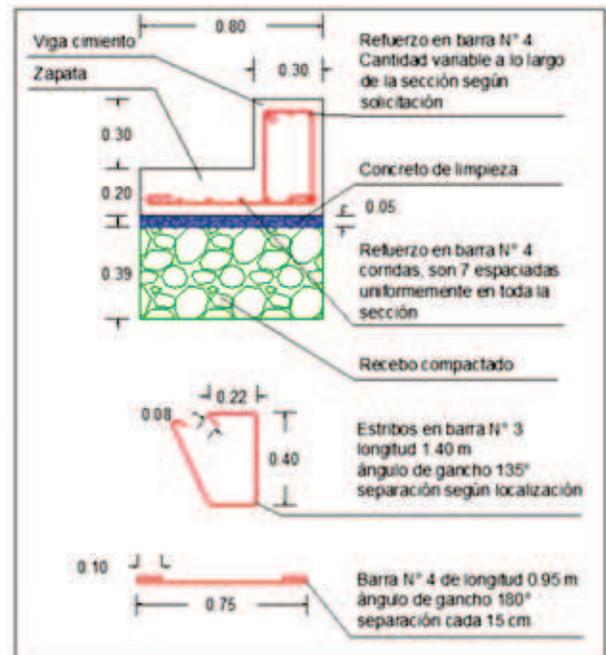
DETALLE CIMIENTOS Fuente: Autores
